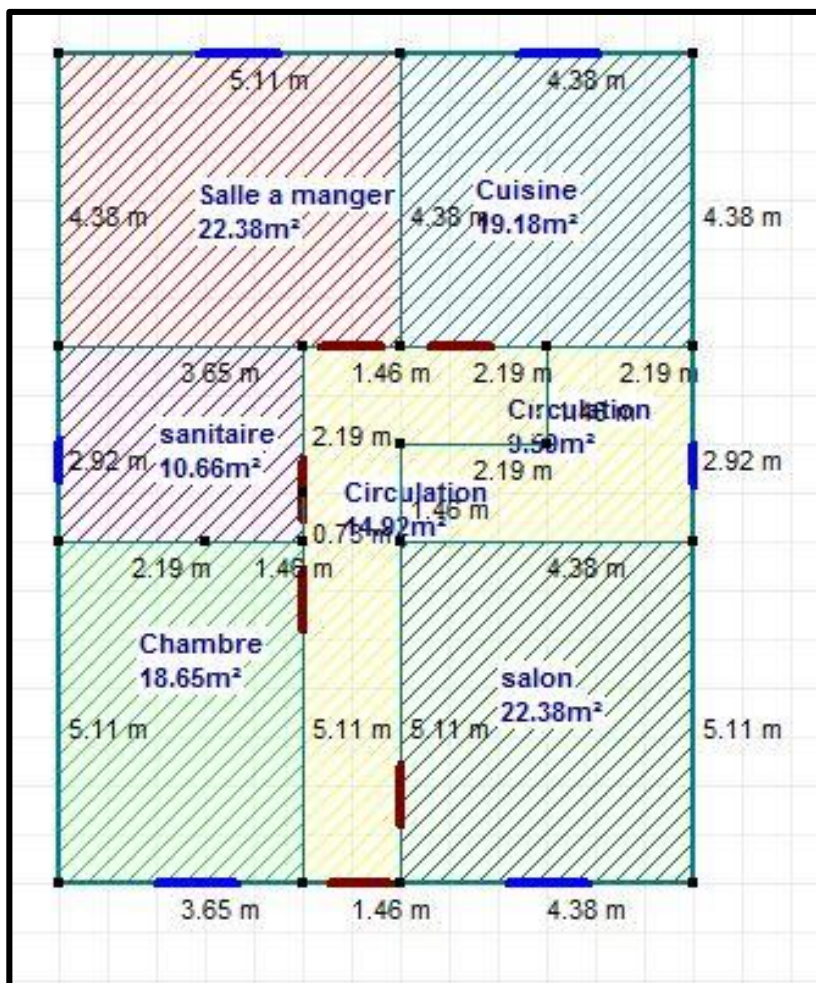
le plan de Rez-de-chaussée sur ALCYONE
